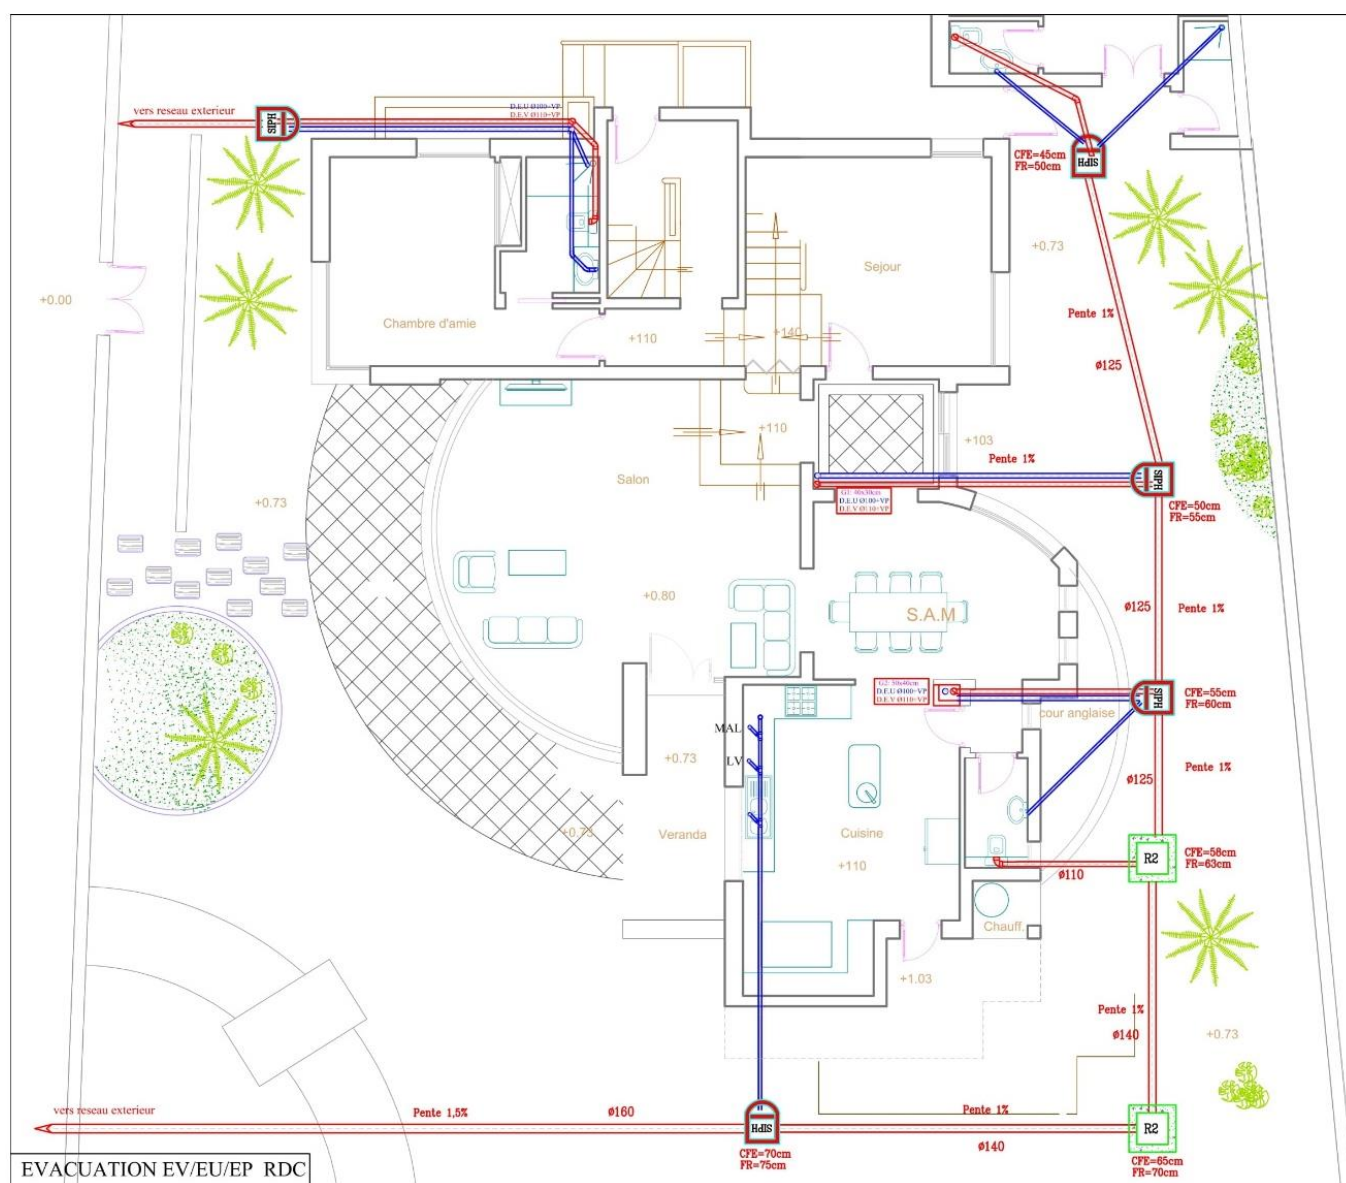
Exemple de plan d'évacuation d' EU+EV
